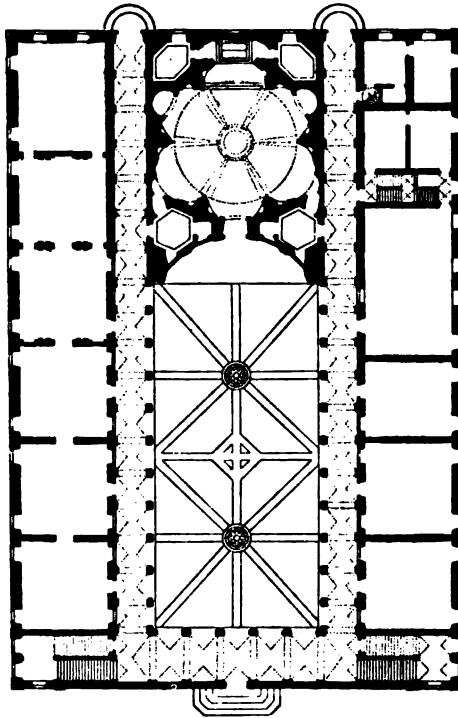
Grundriss der Sapienza zu Rom
